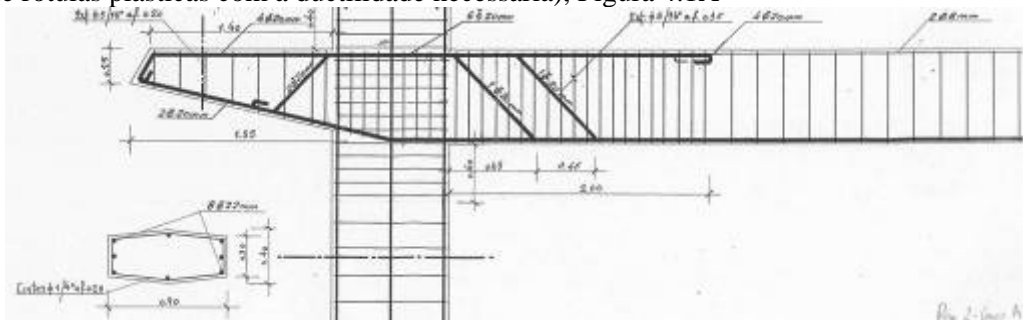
A. Exemplo de deficiente pormenorização de armaduras em viga e em pilar de um pórtico (variação brusca da armadura superior para uma armadura muito reduzida e deficiente cintagem do pilar). Projecto de 1960, com pormenorização muito detalhada e conforme a boa prática da época
